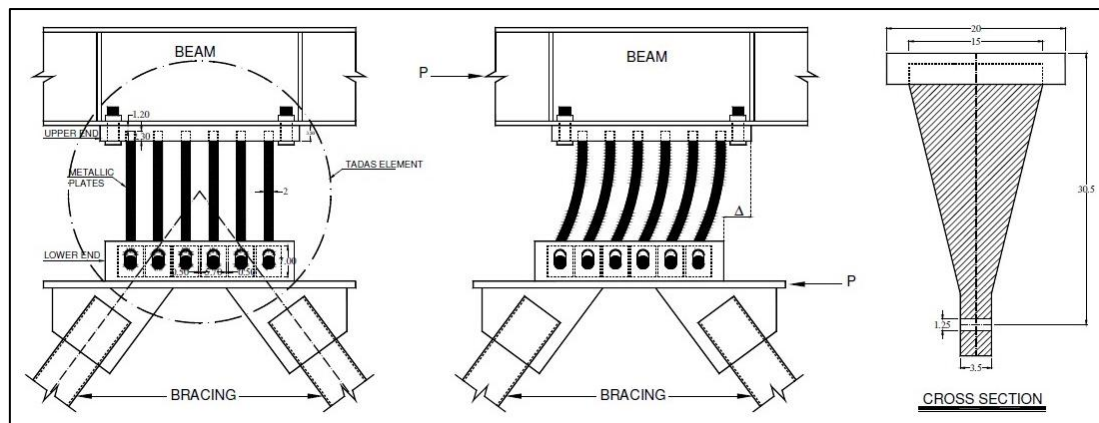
Configuración, deformada y sección transversal de dispositivos TADAS (Alehashem et al., 2008).
